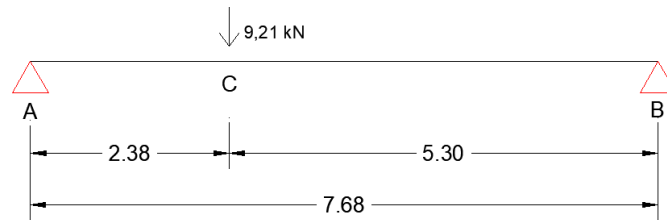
Viga biapoyada carga puntual sobre "C" 9,21 kN
